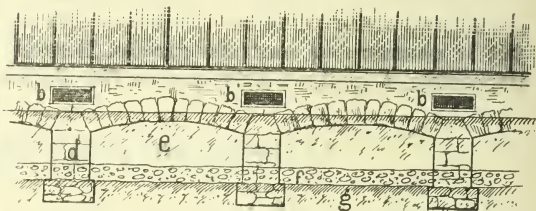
Profil d'un mur de fondation construit sur voûtes.
